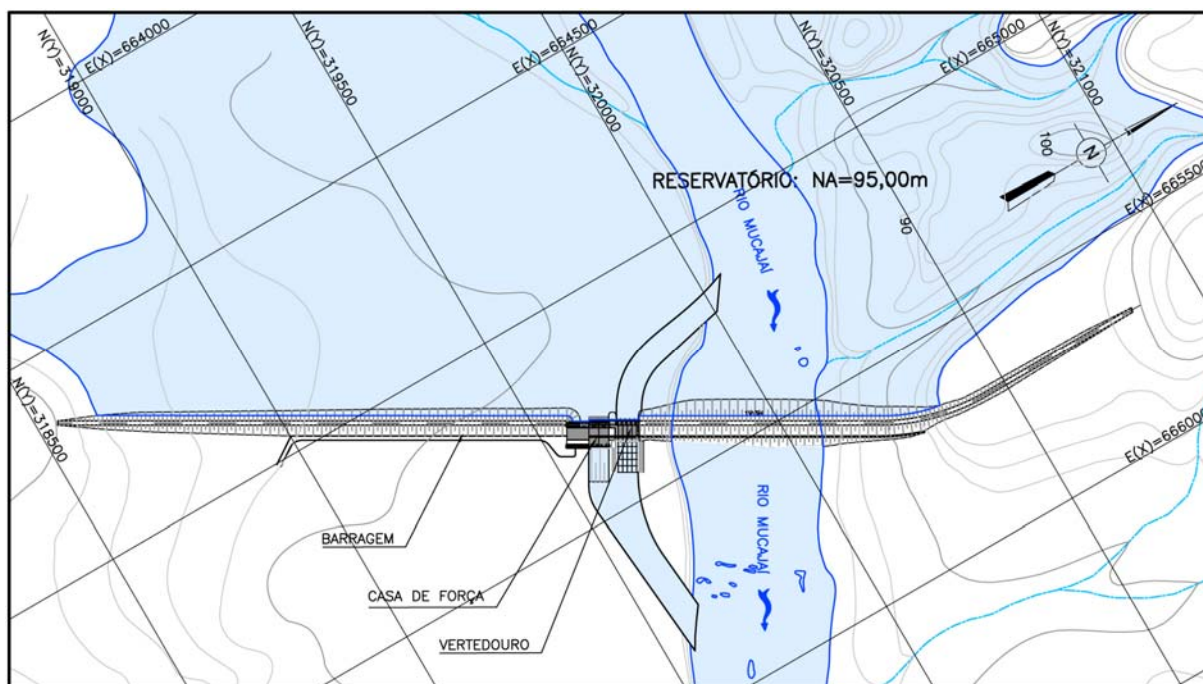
Arranjo Geral do AHE Fé Esperança - Planta
